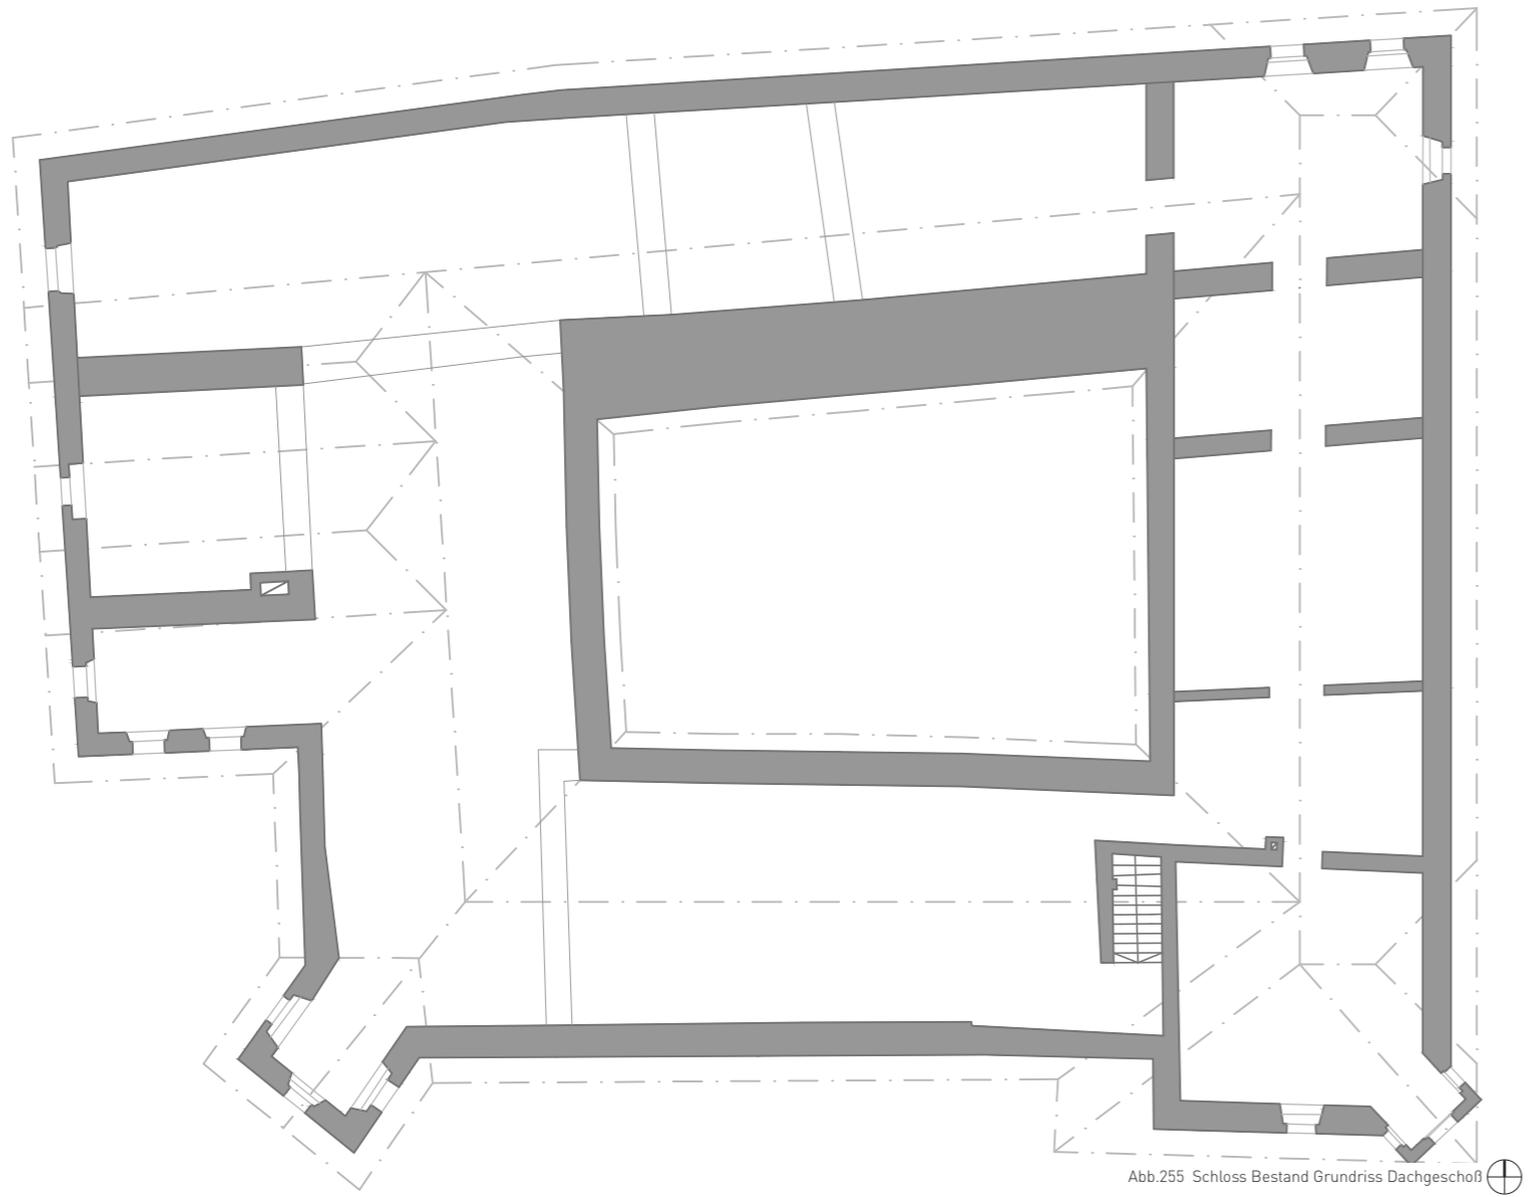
Schloss Bestand Grundriss Dachgeschoß ⊕
